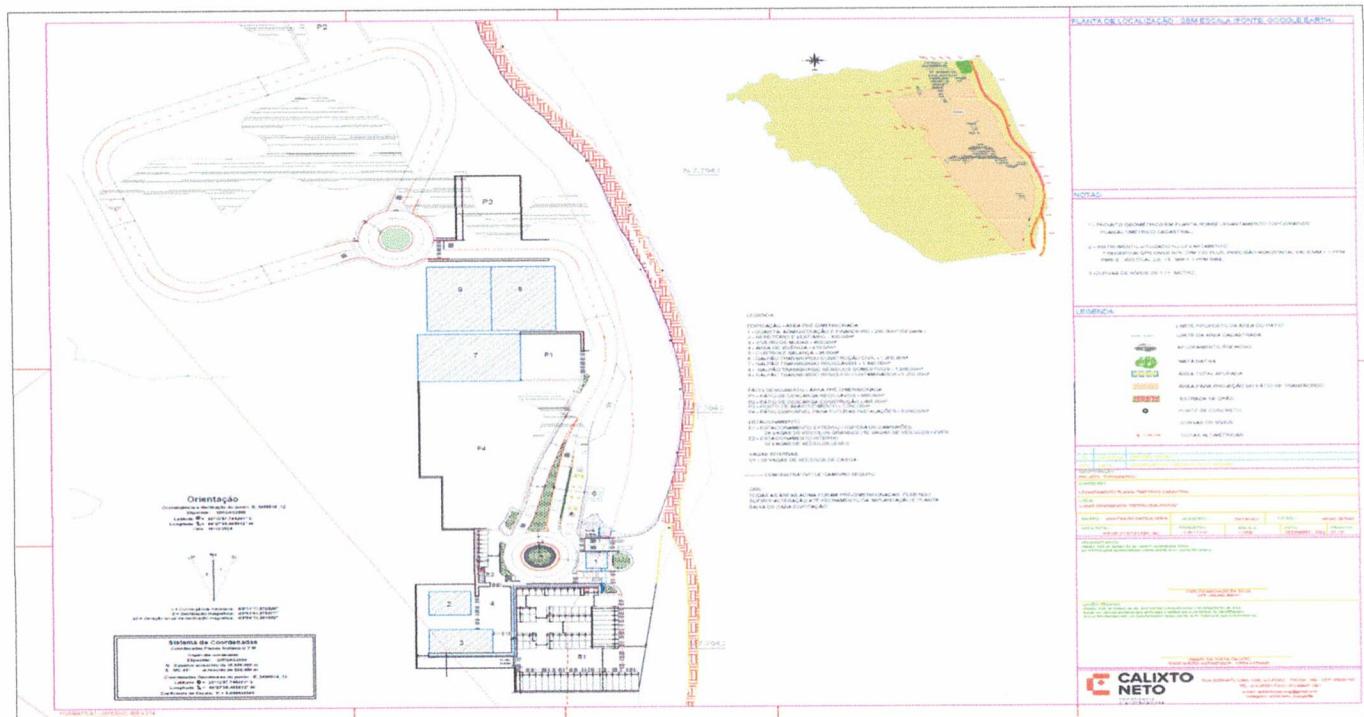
Projeto Geometrico do empreendimento em planta de localização. Fonte: Autos do Processo 55.842/2025.
